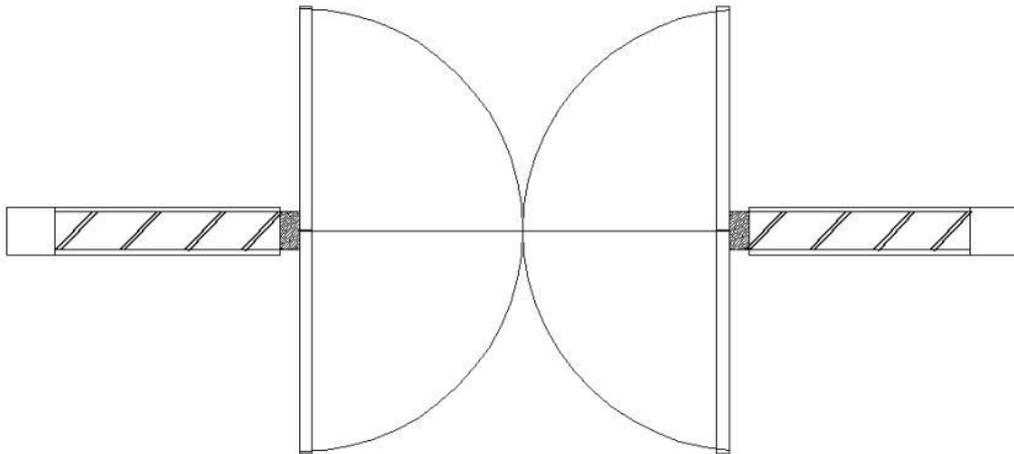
Denah dan potongan pintu dua bukaan dengan ukuran berbeda
